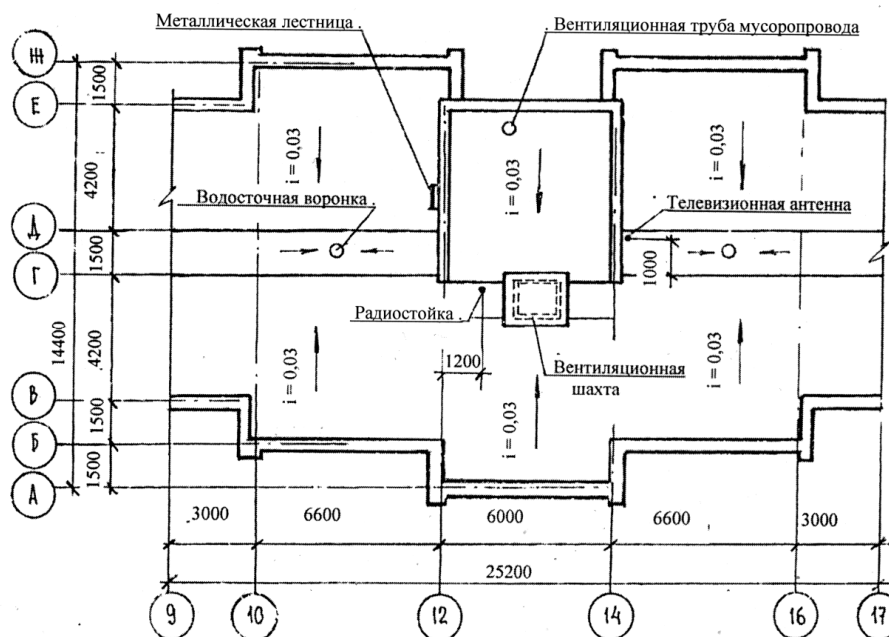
План крыши секции жилого девятиэтажного дома (типовая серия 90-0104.13.86)
